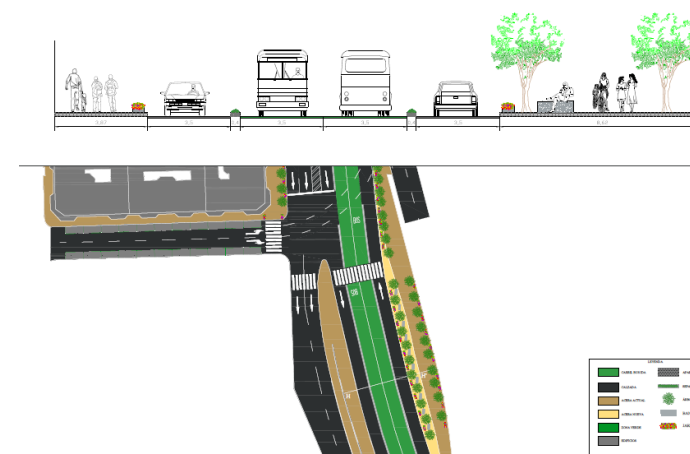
Planta y sección del inicio de la calle Primo Rivera
